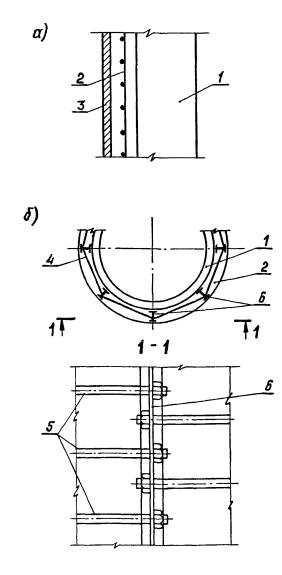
Усиление стен силосов железобетонными обоймами
